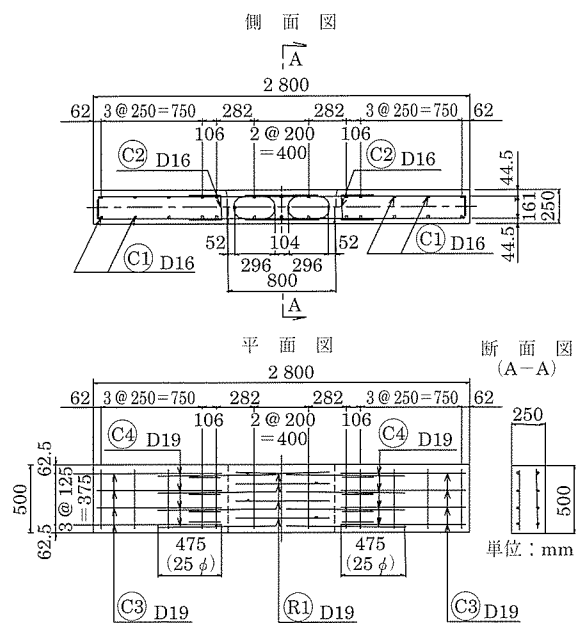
DIN 規定のダブルループ鉄筋継手の鉄筋配置図
